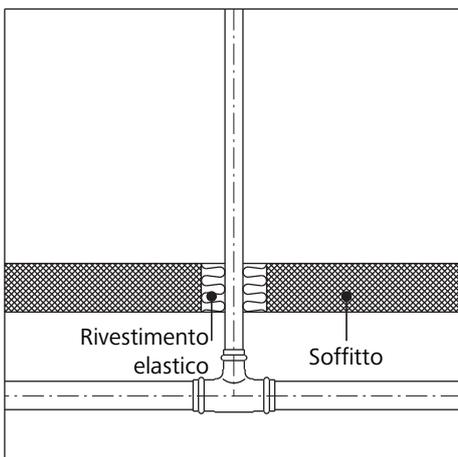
Attraversamenti dei tubi in pareti e soffitti
